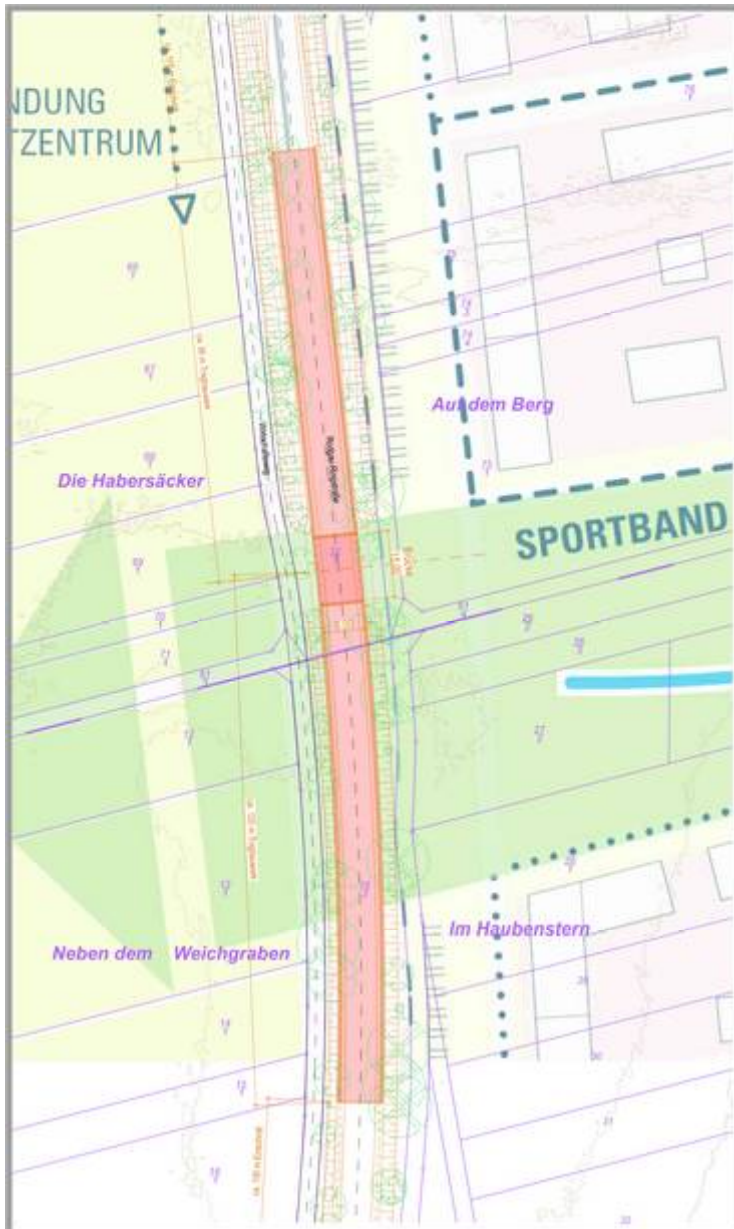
Planungsvariante 3 (niveaugleiche Querung als Überführung) – Lageplan.
